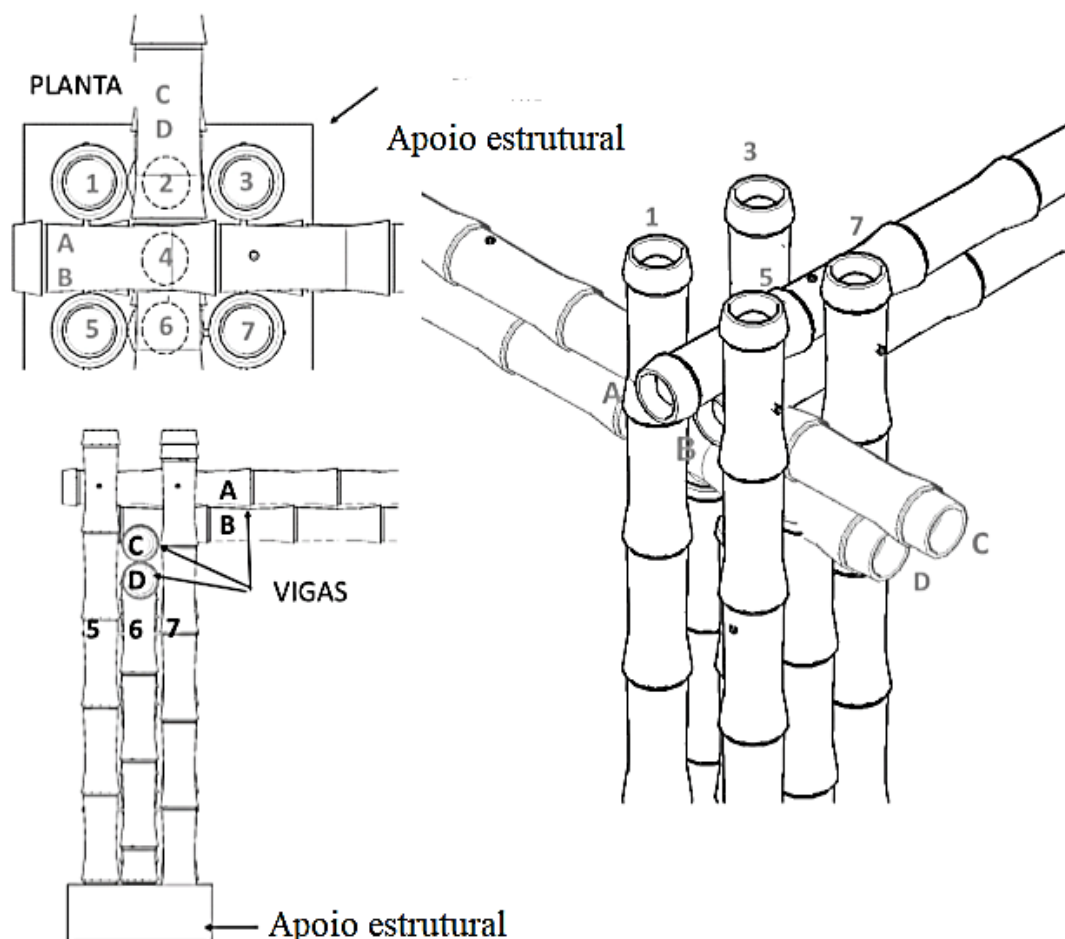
Coluna composta por 7 colmos que suportam vigas duplas transversais.
